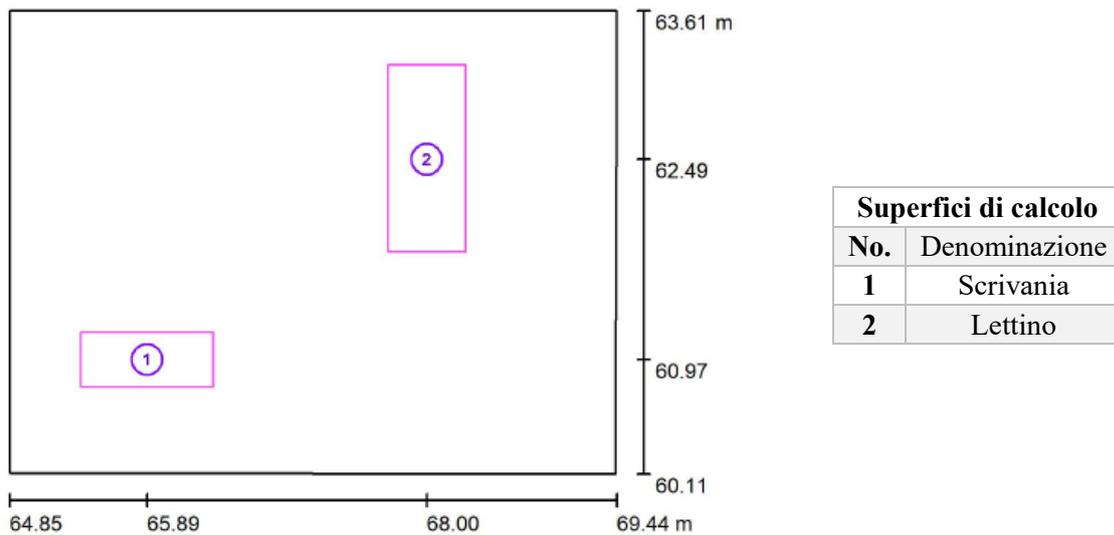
Disposizione in pianta delle superfici di calcolo.
